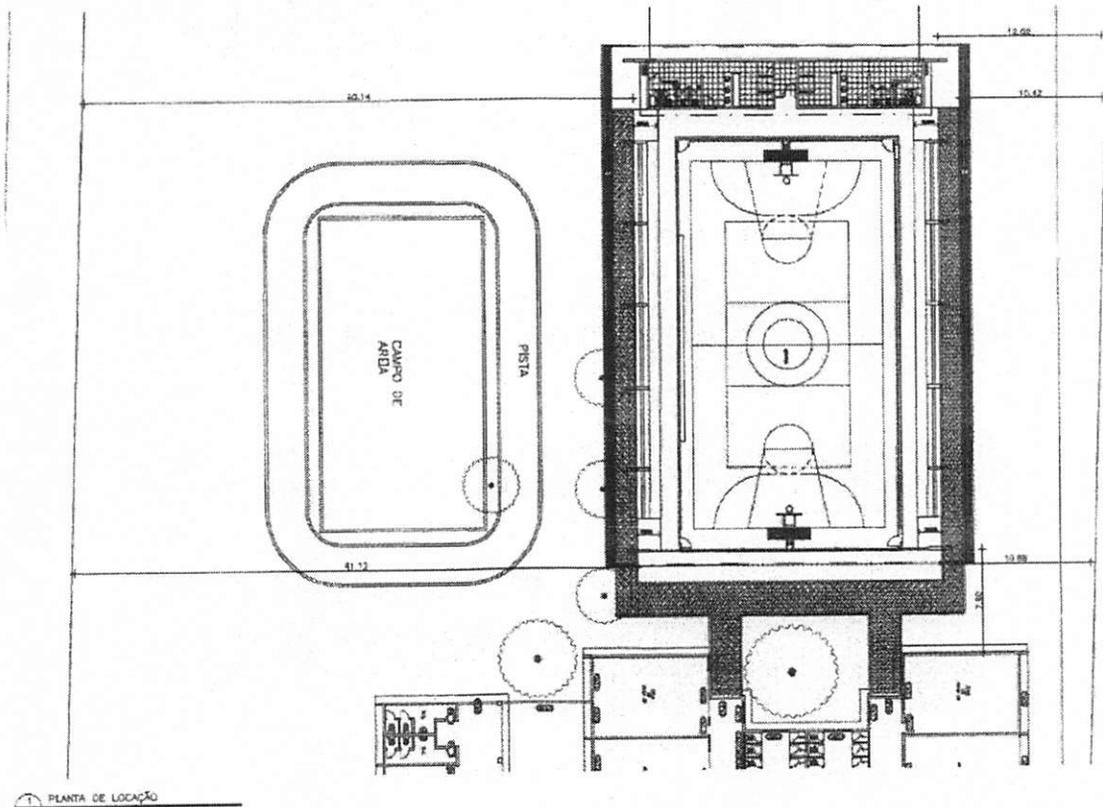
Planta de locação da obra no terreno. Exemplo Creche Pré-Escola
